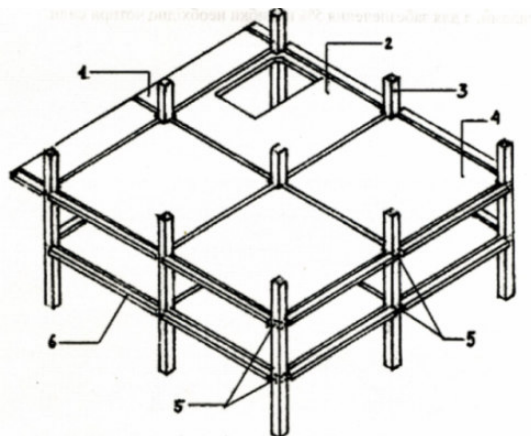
Каркас ІМС: 1 – консольне перекриття; 2 – перекриття з отвором для сходів; 3 – колона; 4 – типове перекриття; 5 – канатна арматура, що напружується; 6 – фасадна розпірка
